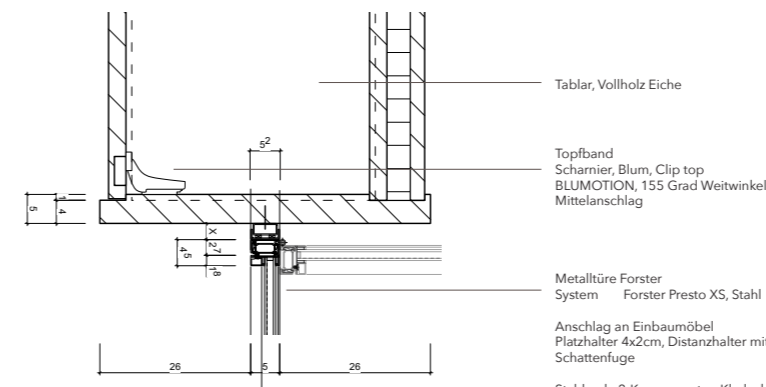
| 1:5 | Einbaumöbel mit Akustikdetails
